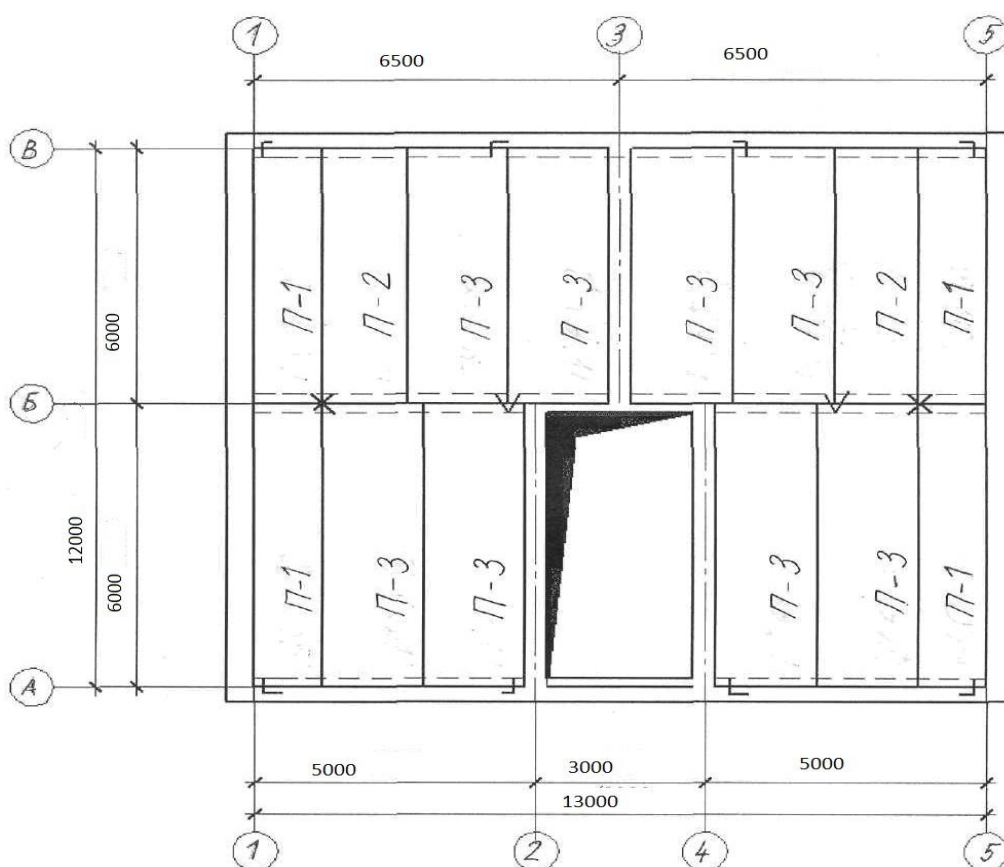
Пример выполнения схемы расположения плит междуэтажного перекрытия
